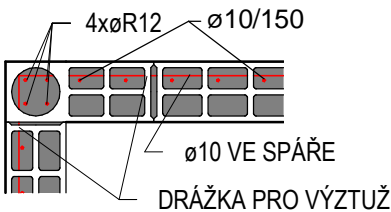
DETAIL VYZTUŽENÍ VĚNCŮ A NADPRAŽÍ
